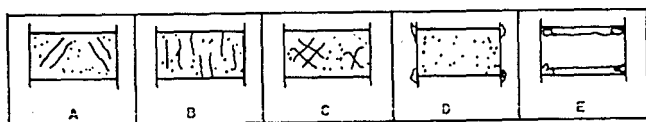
Tipos de fisuras y grietas
